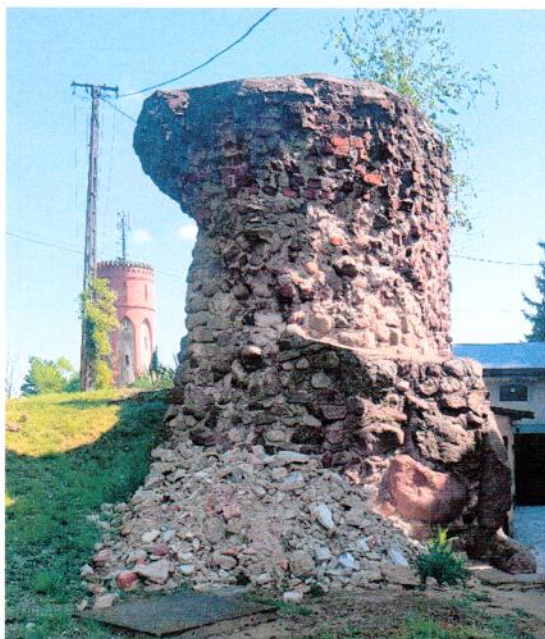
Korona muru parczanu z widocznymi naprawami zaprawą cementową
